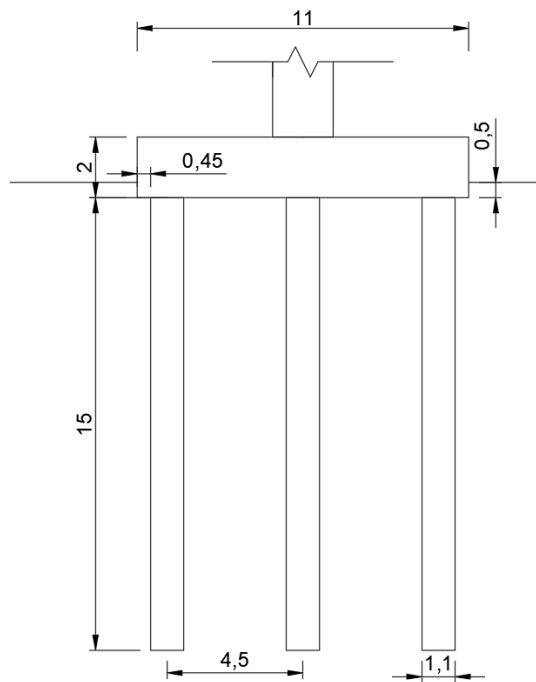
Vista lateral de los pilotes usados para fundar las pilas del puente.
